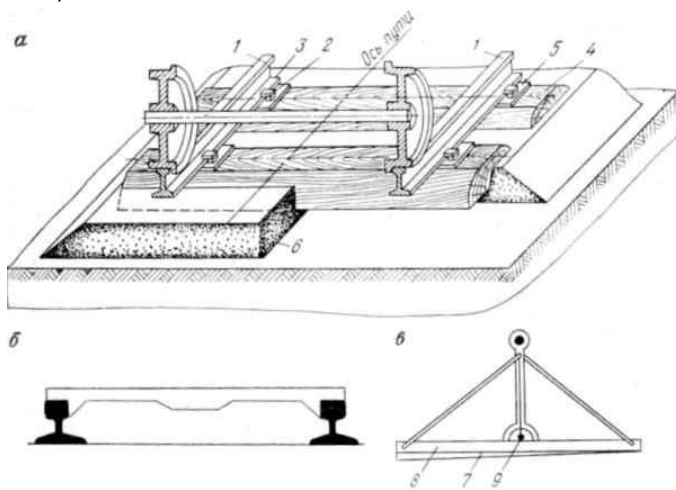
Будова рейкового шляху: а – верхня будова; б – шляховий шаблон; в – ватерпас; 1 – рейка; 2 – костиль; 3 – робочий кант рейки; 4 – шпала; 5 – підкладка; 6 – баласт; 7 – горизонтальна рейка; 8 – нашивка; 9 – відвіс
